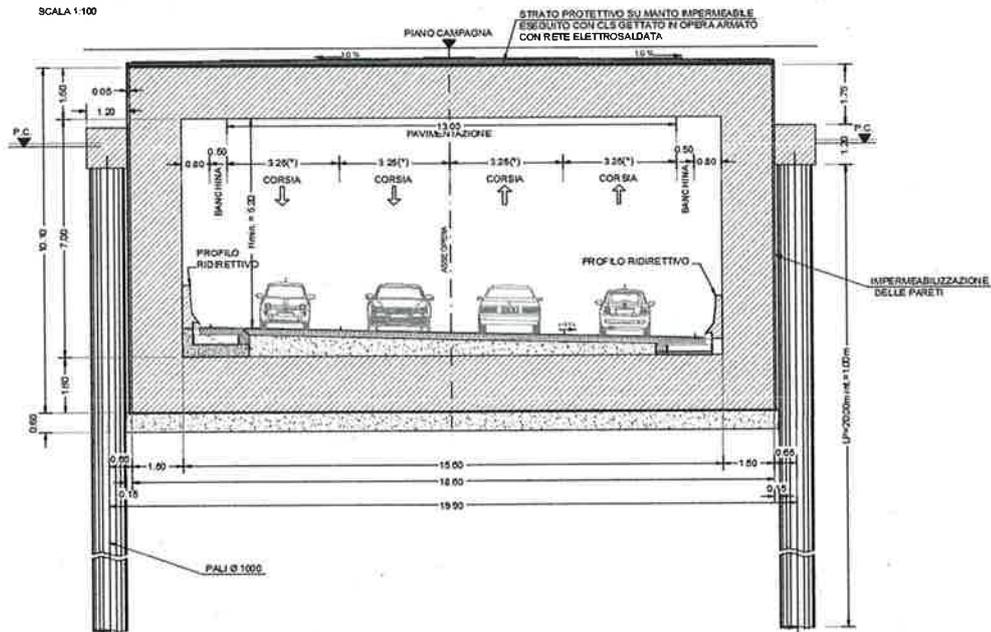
Sezione trasversale in trincea sottopasso dell'Oreficeria – Fase di cantiere
